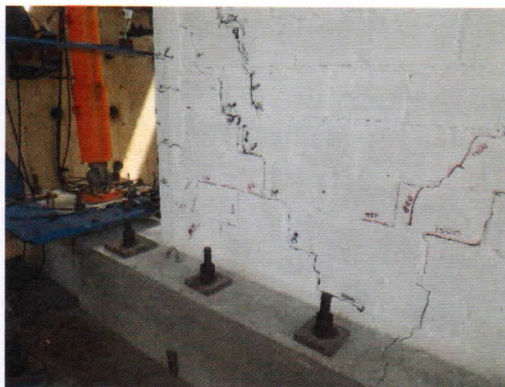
Formación de grietas diagonales en la parte inferior Oeste de la cara Sur para una distorsión de 1/550.
